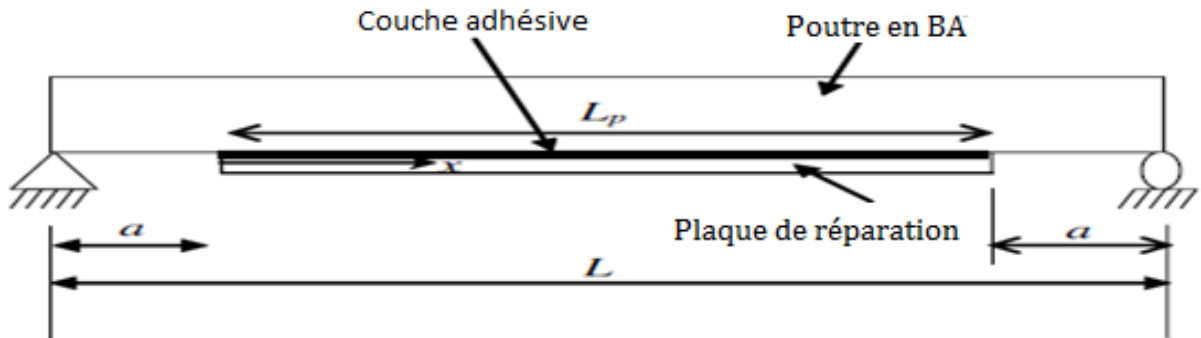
Poutre simplement appuyée et renforcée par une plaque collée
